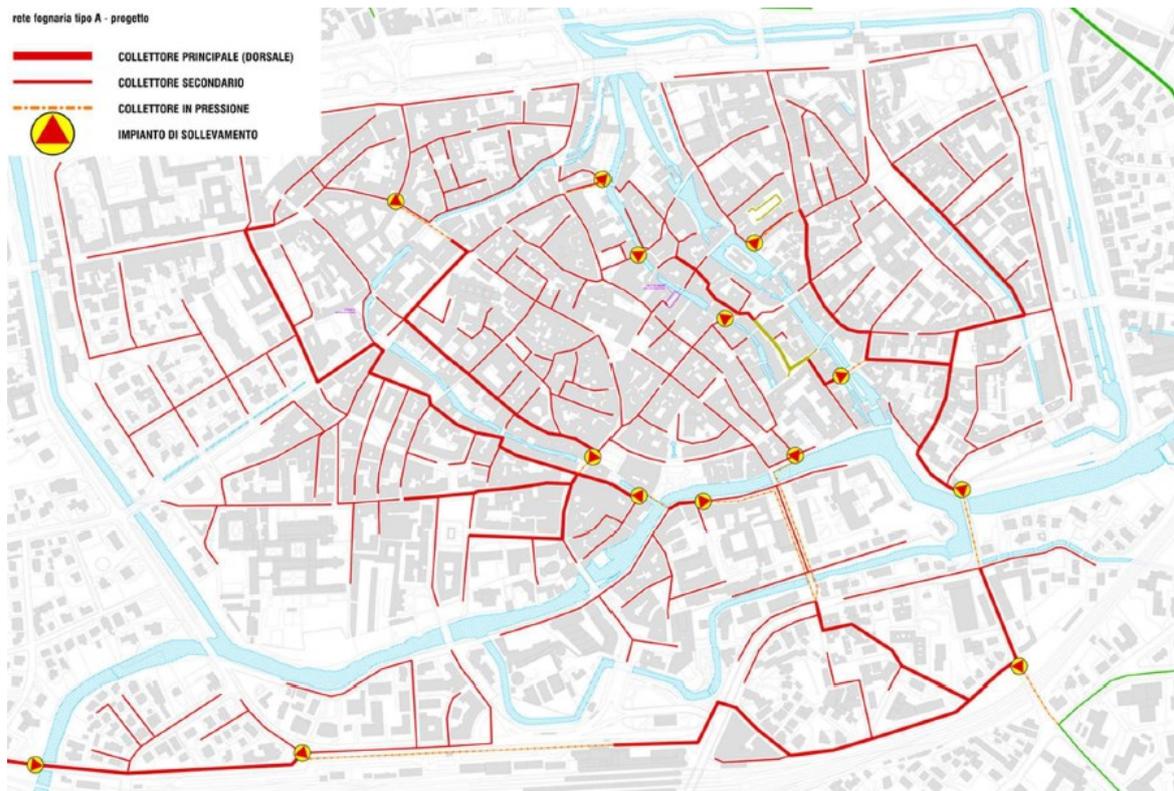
Planimetria di progetto rete fognaria nell'area del centro storico.
